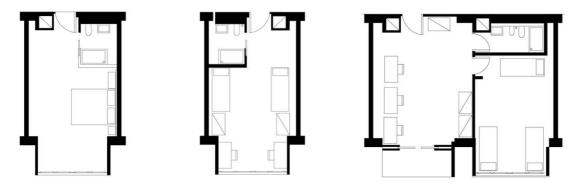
Piante tipologie alloggi (stanza singola/stanza doppia/stanza tripla)
